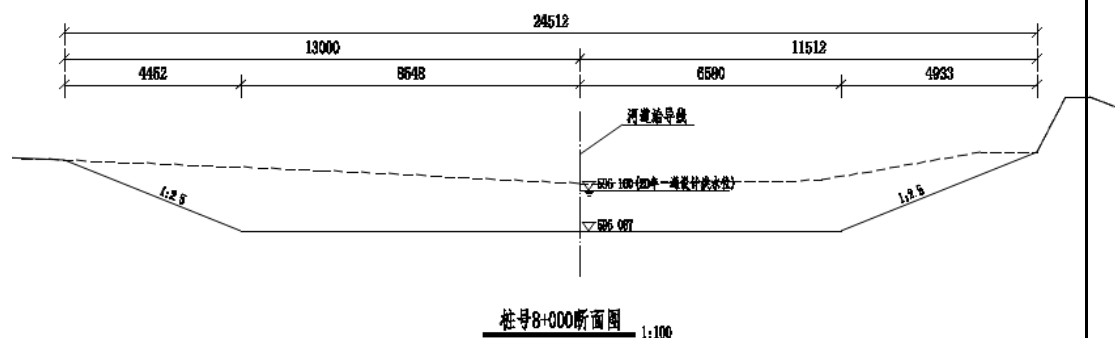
三里墩沟桩号 8+000 断面设计横断面图
